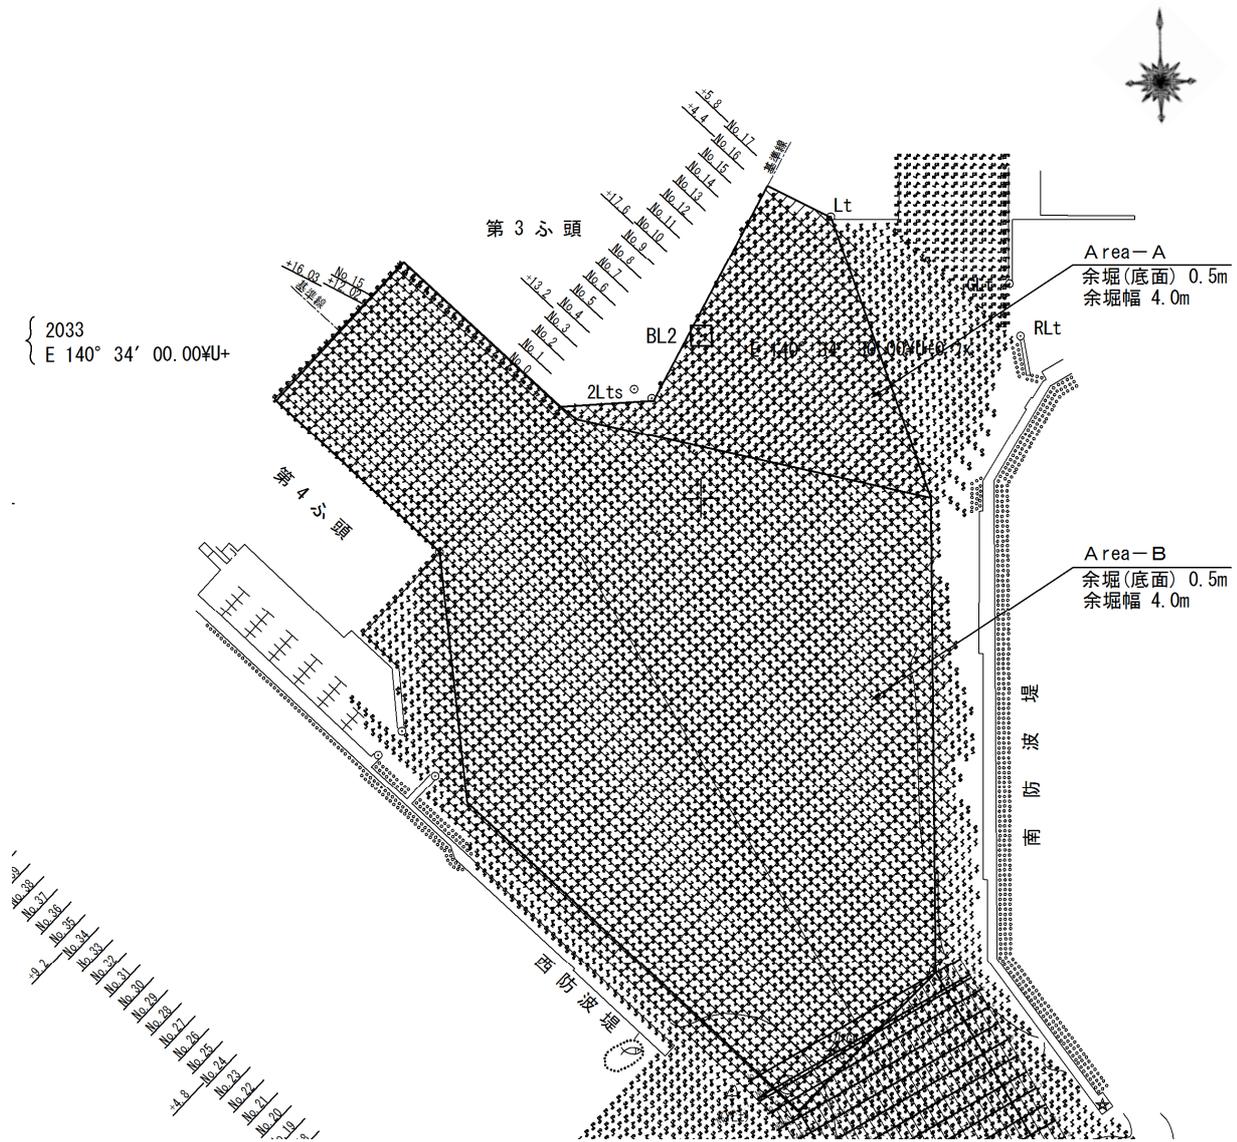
No.2 大洗港区_中央地区泊地 (-8m) の平面図 (被災前)
